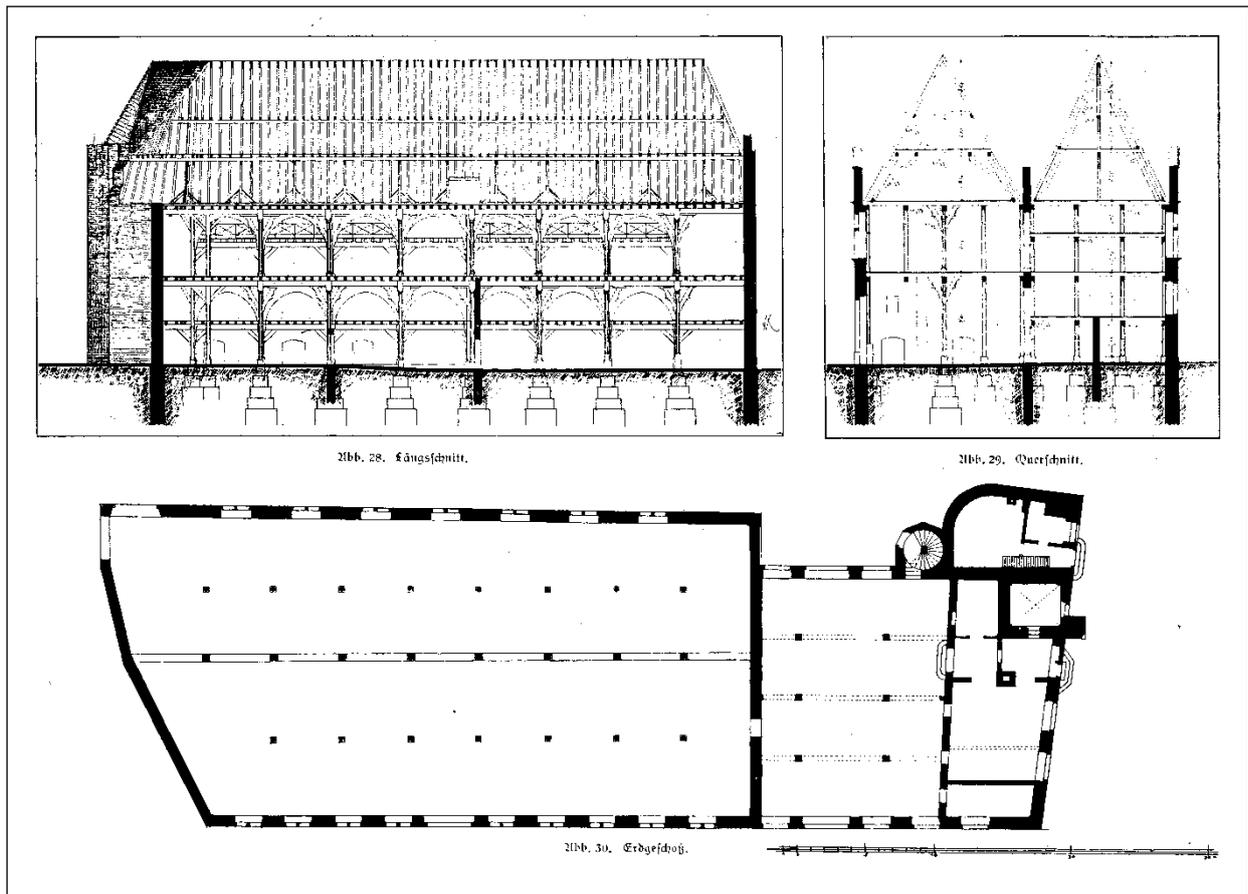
Schnitte und Erdgeschossgrundriss des Stapelhauses vor dem Umbau.
